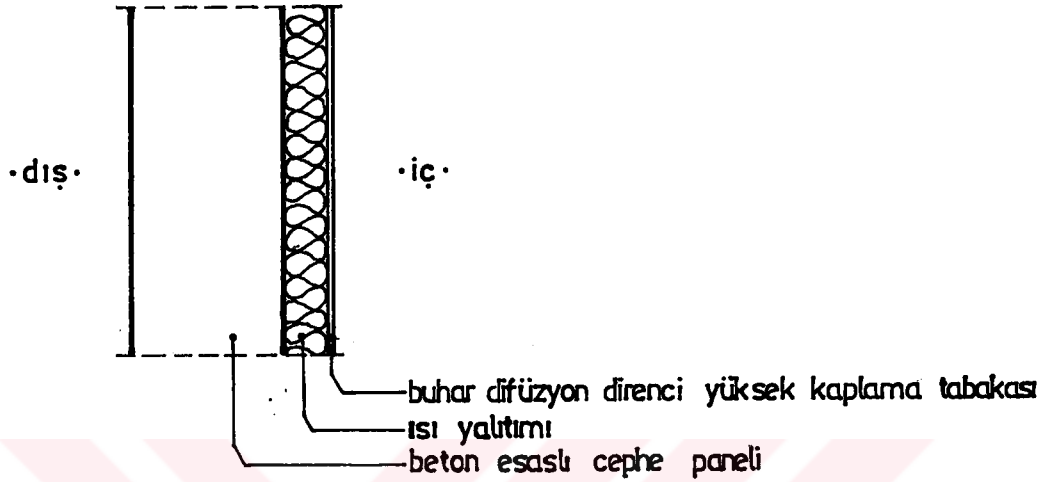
Beton Esaslı Sandviç Cephe Paneli
